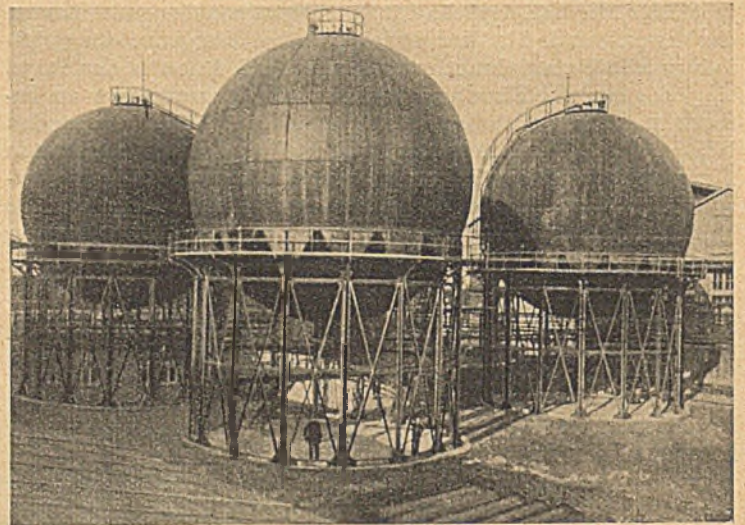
Schwefelsäurebehälter für die I. G. Farbenindustrie A. G., Höchst a. M.
